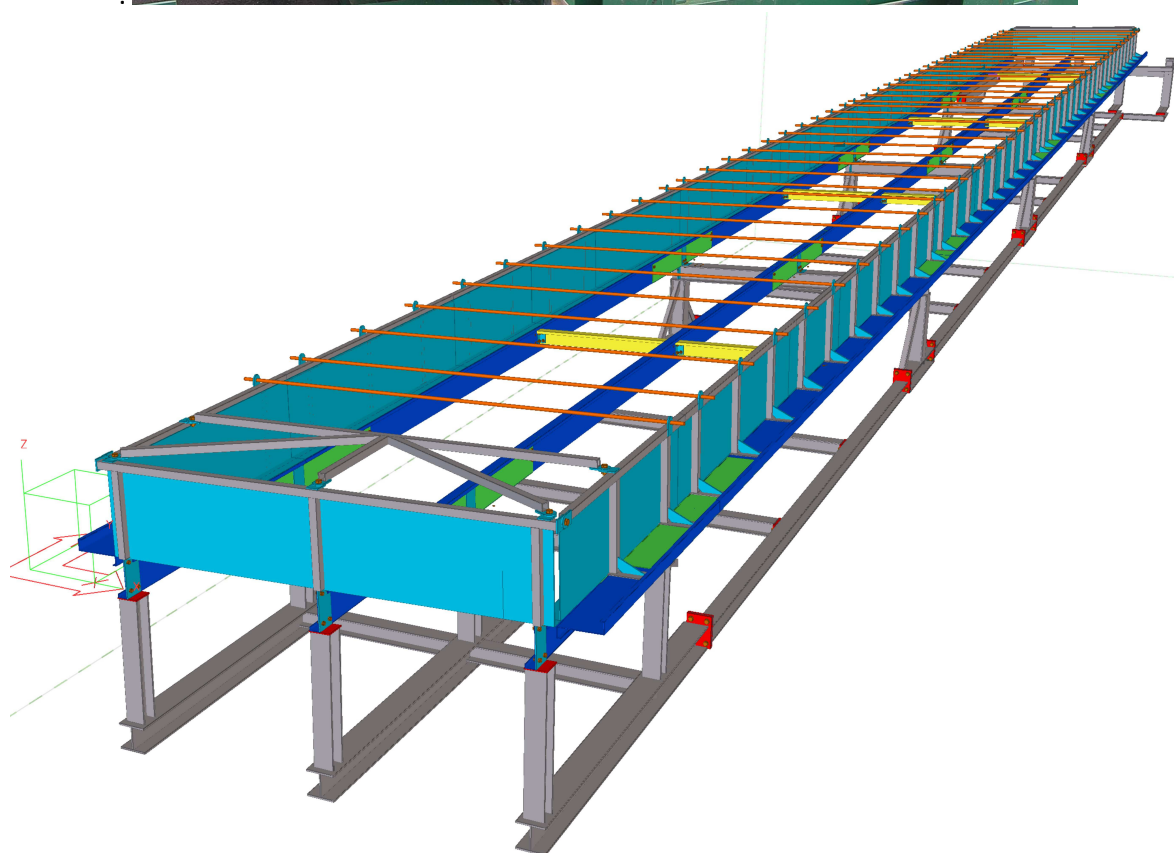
VISTA GENERAL DE MONTAJE PREVIO AL ENSAYO
